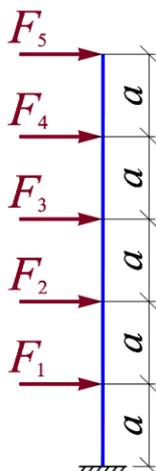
Упрощенная расчетная схема решетчатой башни на действие ветровой нагрузки (рисунок авторов)
